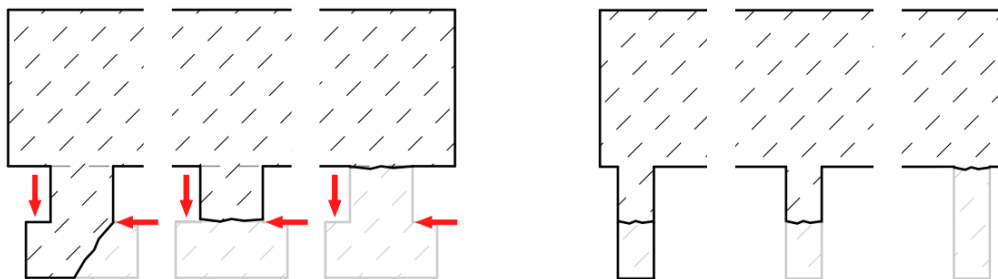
Längsschnitt (li) und Querschnitt (re) des Versagens unter Querlast durch den Verbindungspartner Einhängekomponente und Betonbruch in Form eines Betonausbruchkegels (jeweils li) oder an einer geometrisch oder materialspezifisch bedingten Schwachstelle (jeweils m und re)
